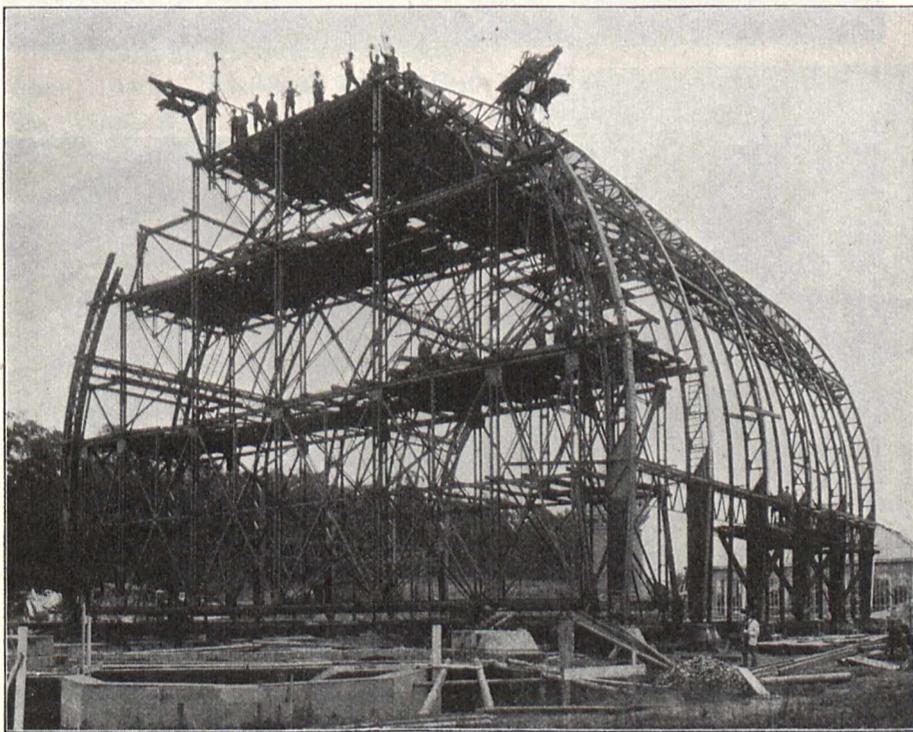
Großes Tropenhaus. Aufstellung des Eisengerüsts.
